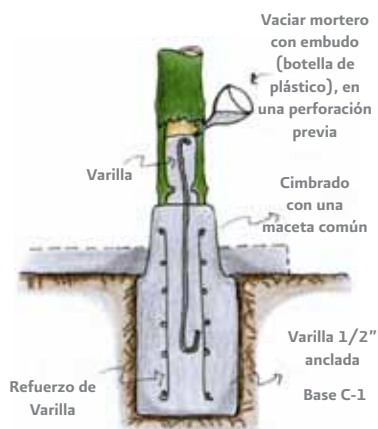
Anclaje de columnas, pies derechos. Elementos verticales a la cimentación con varilla de refuerzo.
